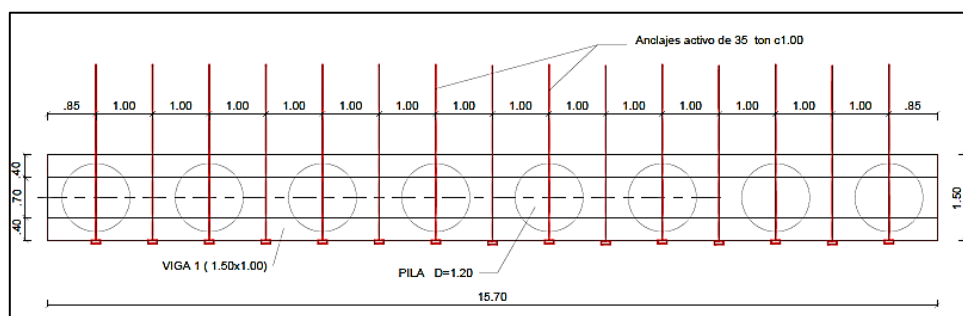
Planta estructural de ubicación de elementos de superestructura y anclajes. Empresa San Simón S.A 2015.
